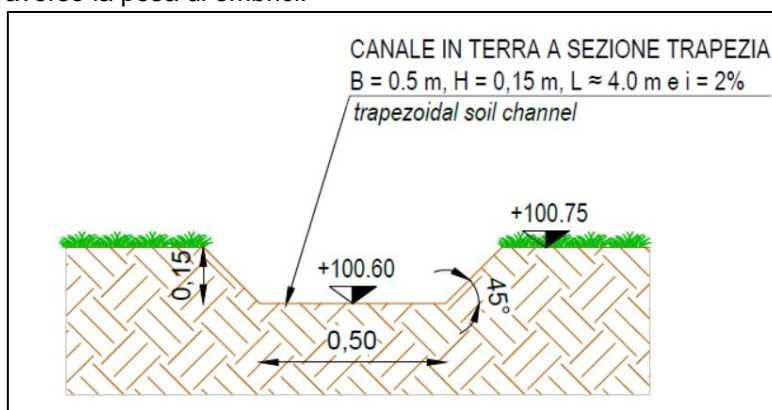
sezione di imbocco canale di sfioro – Parcheggio P1
